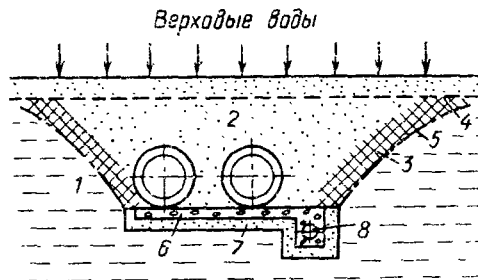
Схема увлажнения изоляции бесканального трубопровода:
